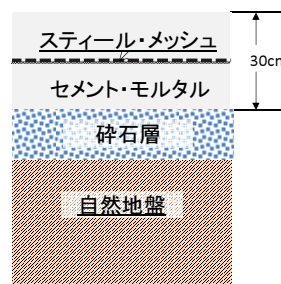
工場 1 階床構造 写真-1 モルタルひび割れ
